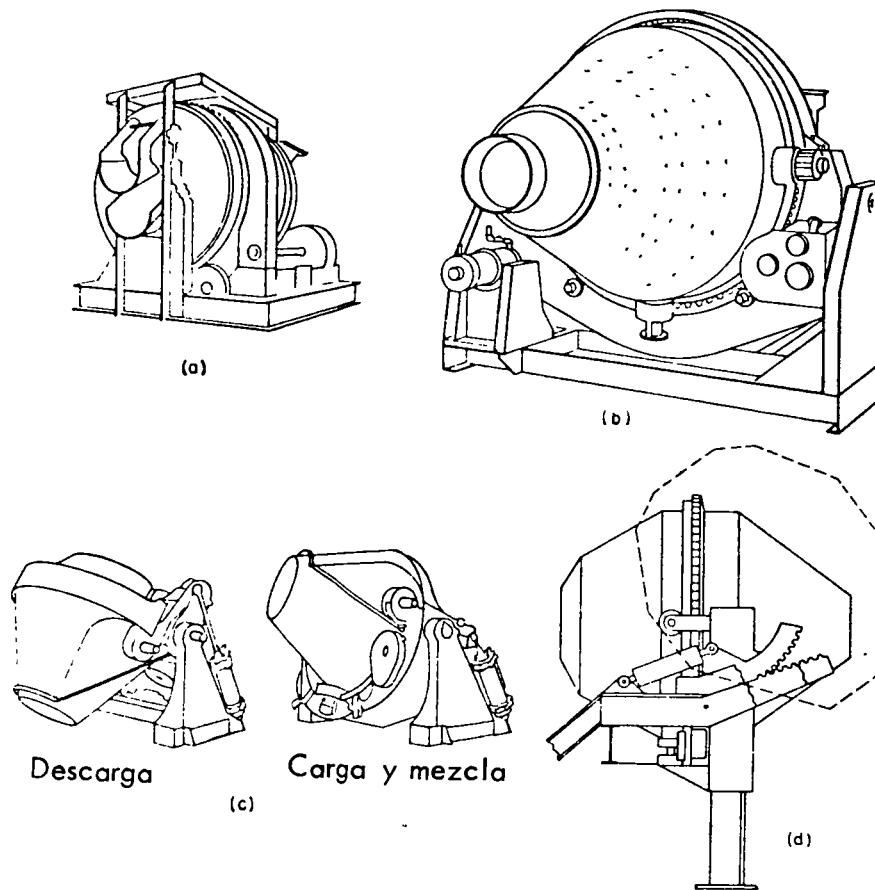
Plantas Revolvedoras de concreto de mezclado por caída libre.
